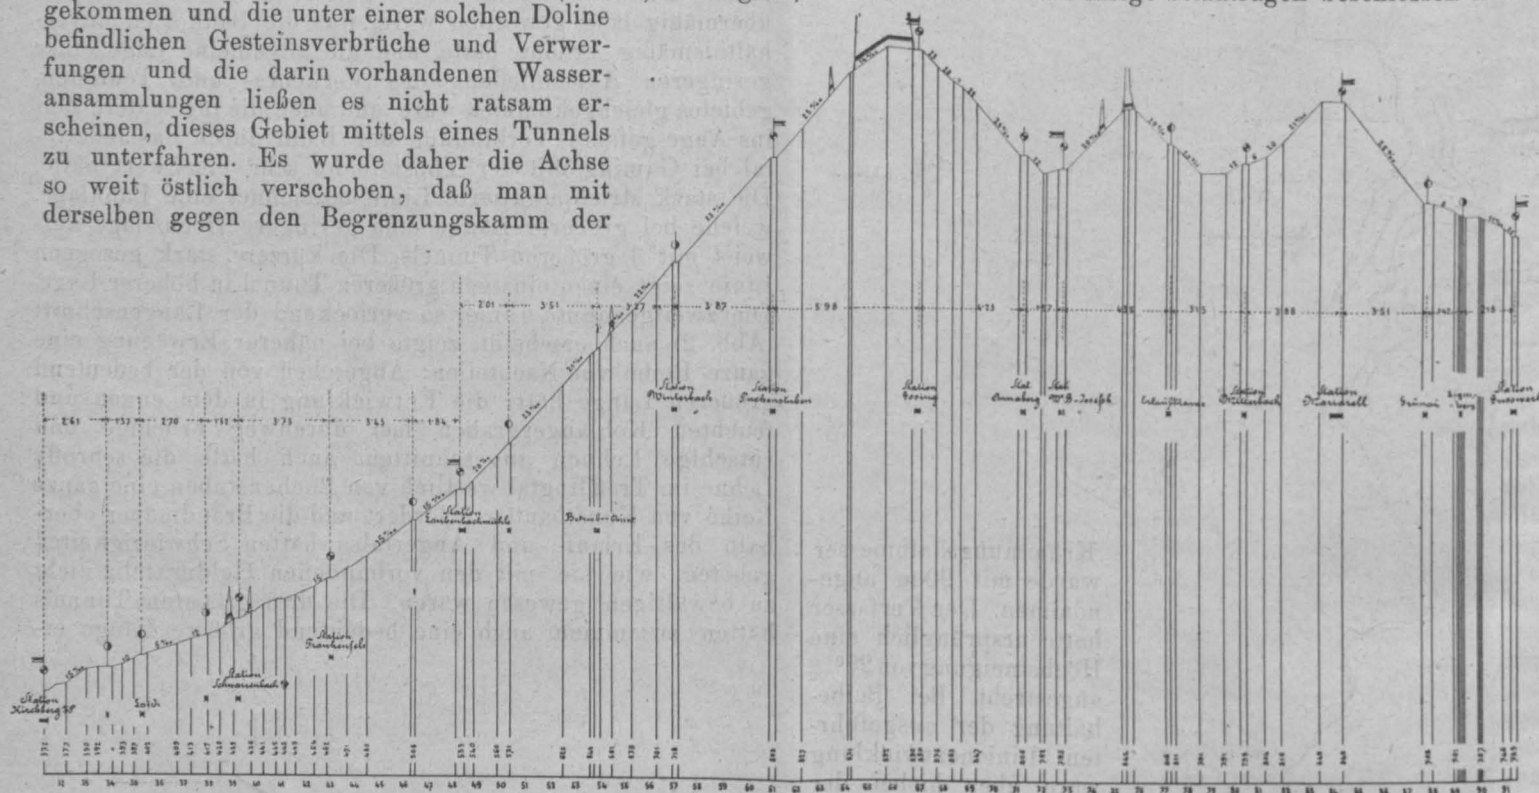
Längenschnitt der zur Ausführung gelangten Linie.
